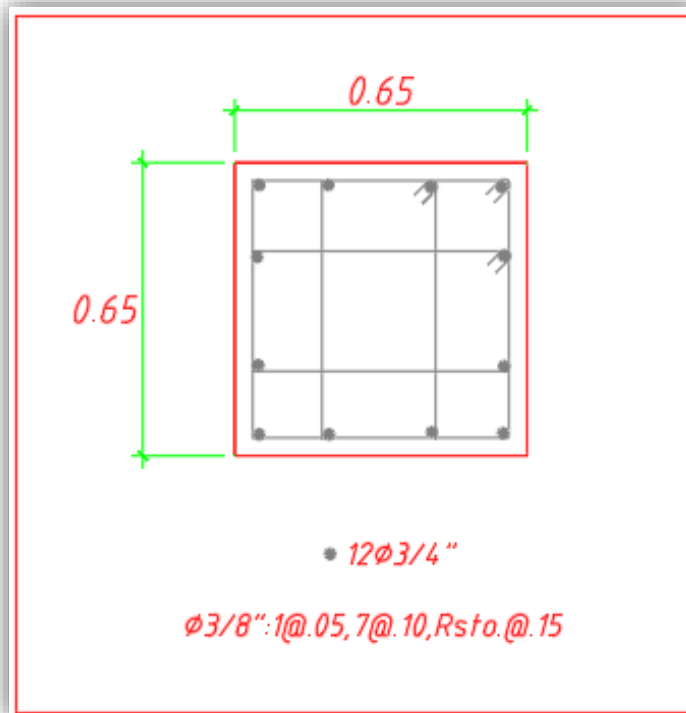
Detalle de refuerzo en columna C3 piso 1 al 3
